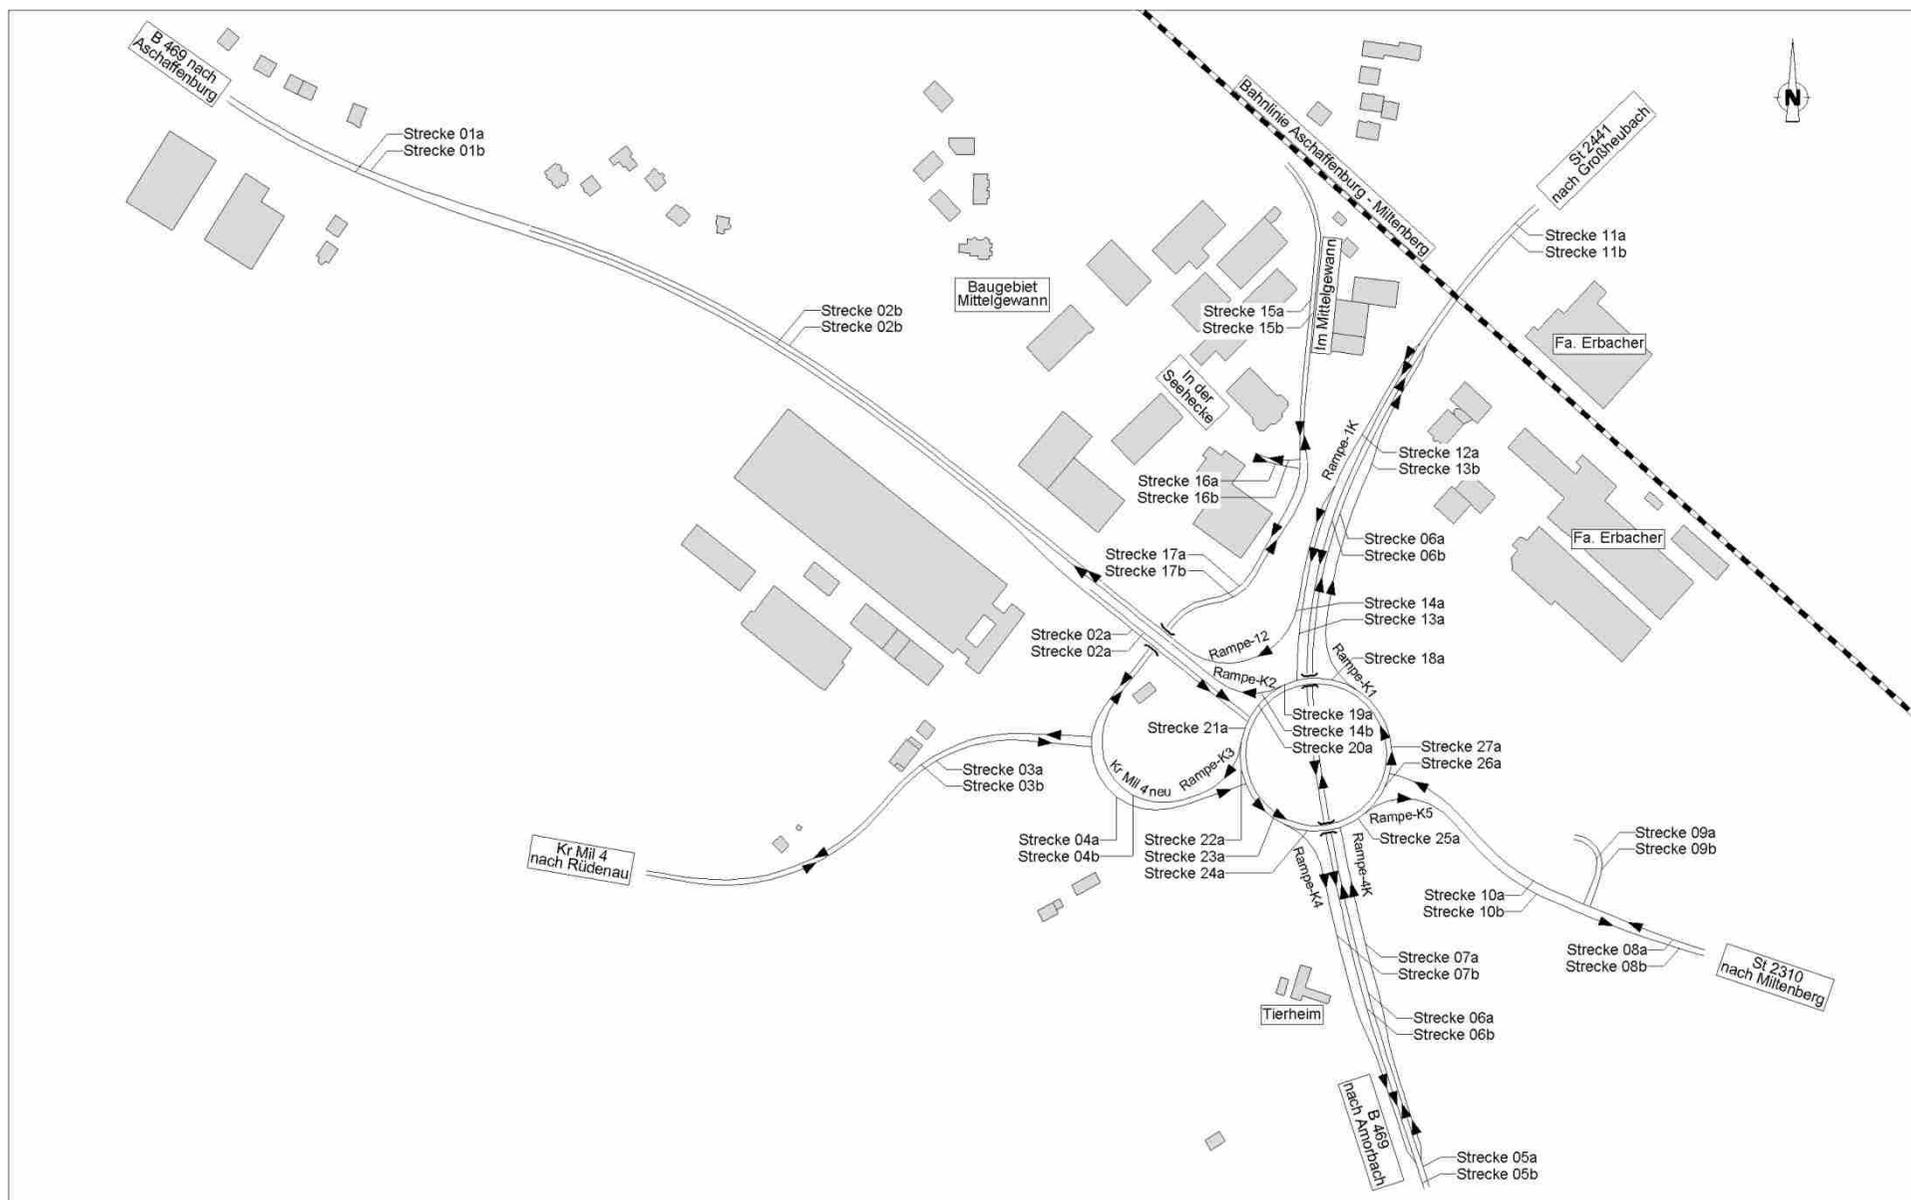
Lage der Streckenabschnitte im geänderten Straßennetz (Planung, Berechnung B)
